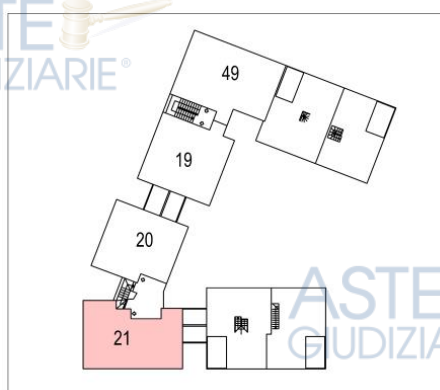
Individuazione della collocazione del subalterno 21 sulla planimetria del piano secondo del condominio
